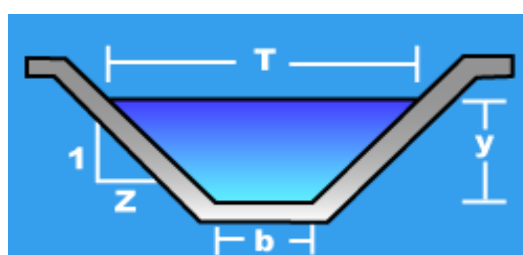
Sección de las cunetas proyectadas. Fuente: Hcanales.
